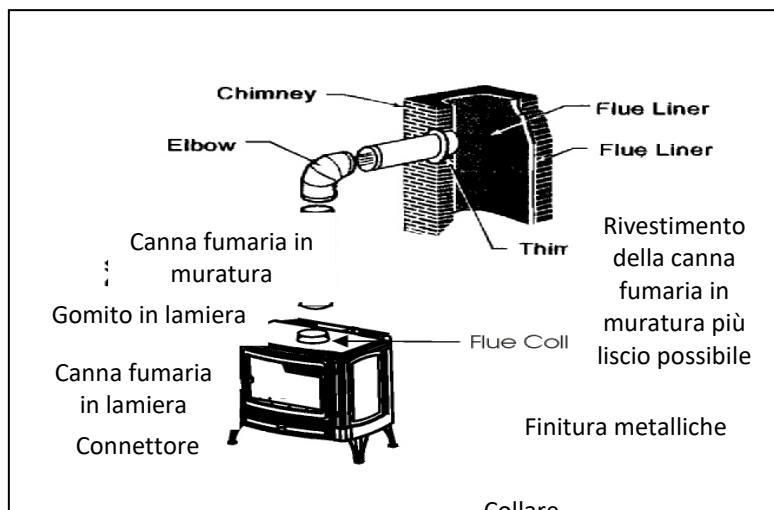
Esempio di collegamento alla canna fumaria in muratura.
